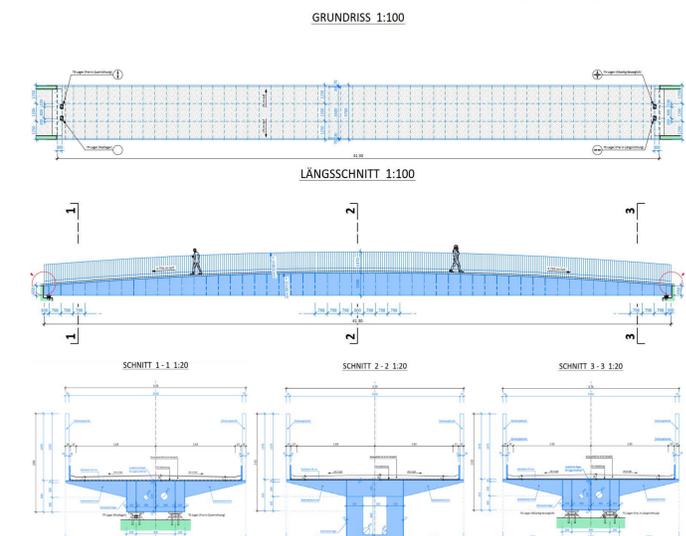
Grundriss, Längsschnitt und Querschnitte des Stahlbauplans
